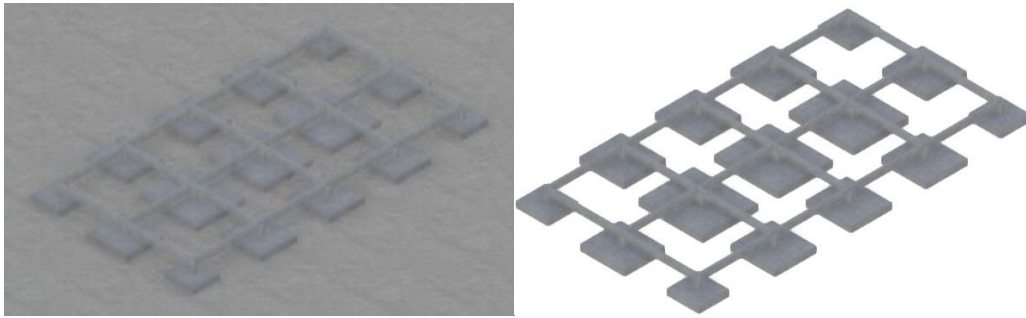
Fundações superficiais do tipo sapata, para o caso de solo semi-infinito argiloso seco ligeiramente plástico.
